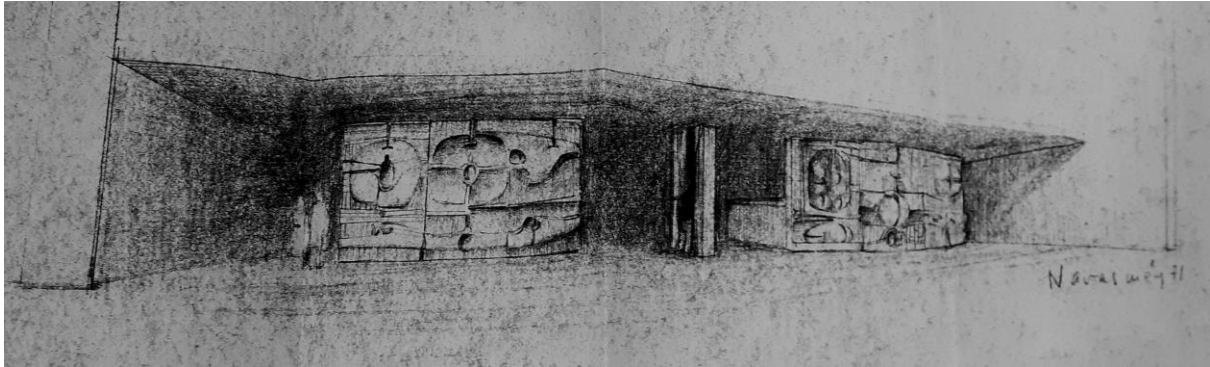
Relieves del arranque de las escaleras del vestíbulo de la planta baja del aulaio
